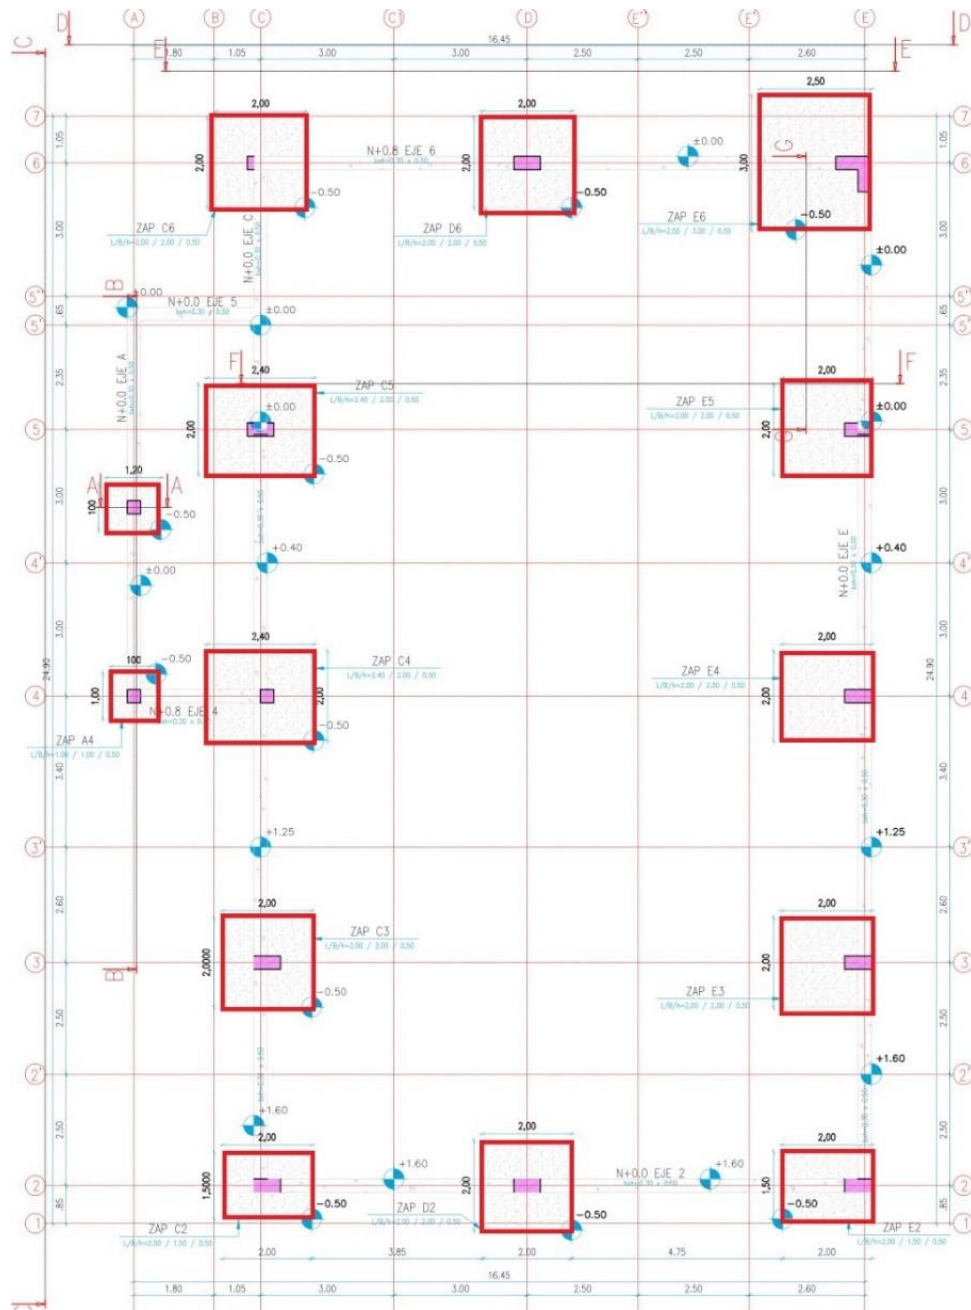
Localización de zapatas. Fuente: Planos del proyecto
